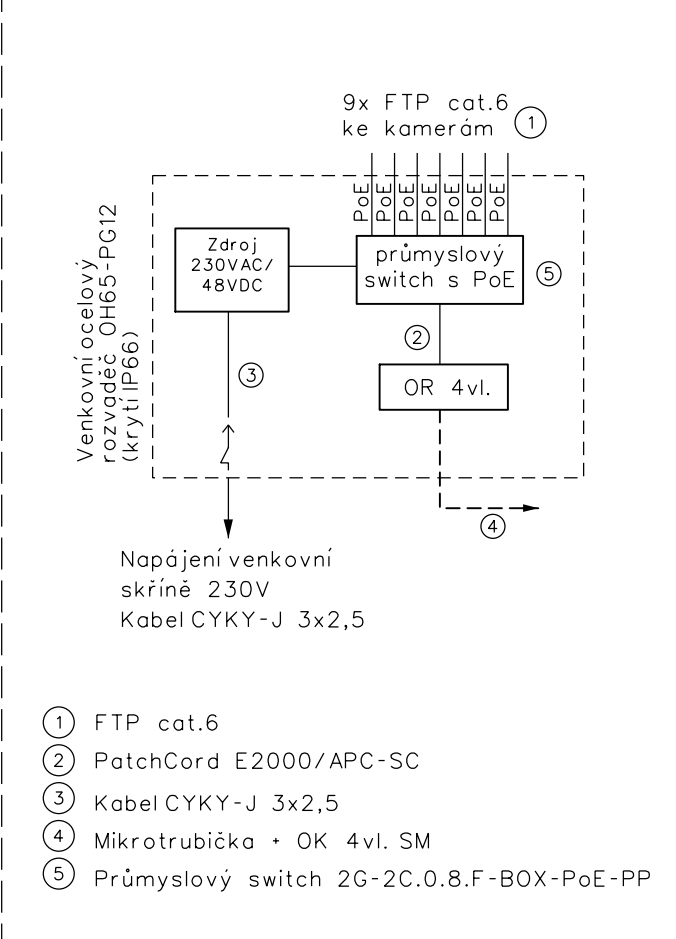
## DETAIL ZAPOJENÍ SKŘÍŇE - TYP A
